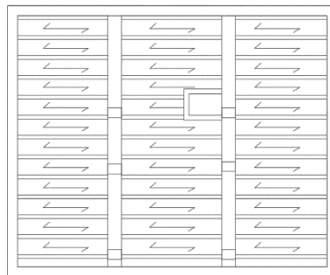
Planta de estructura entre Planta Primera y Planta Segunda. Fuente: CAD propio
